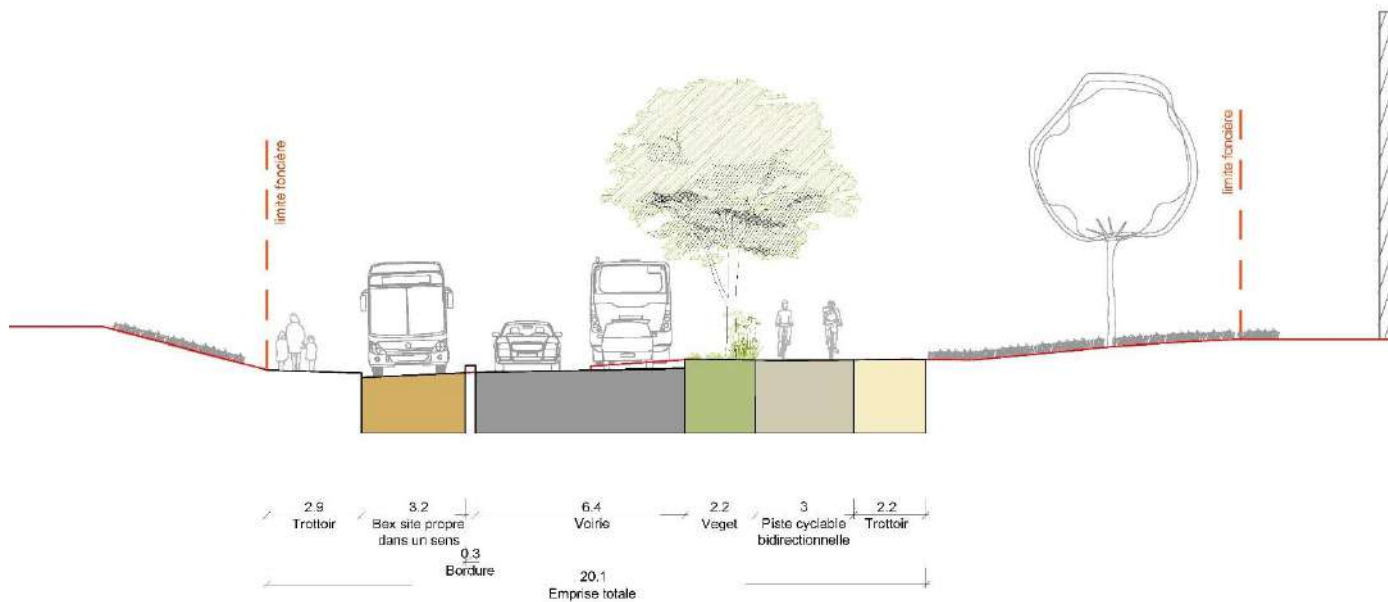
Coupe type sur l'avenue Pierre Proudhon
